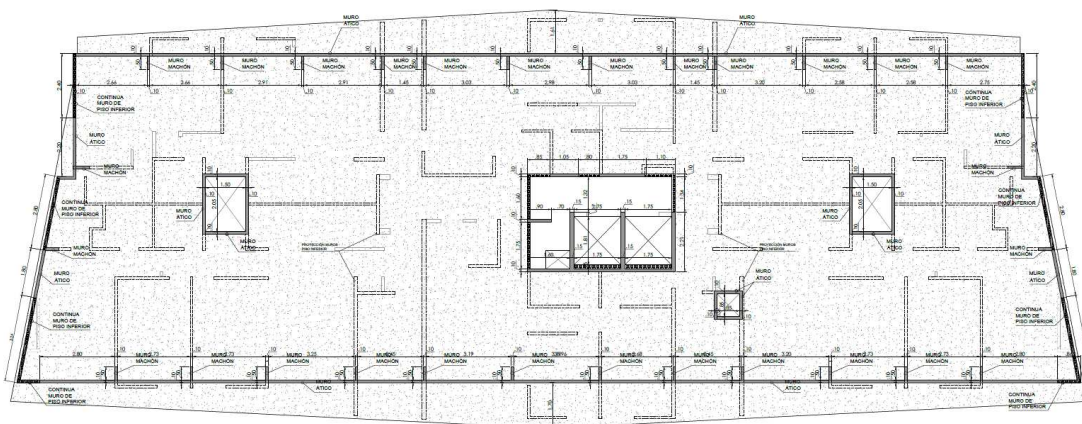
Planta Estructural Piso 19 áticos, muros $e=.10$ m. Fuente: Elaboración propia.
